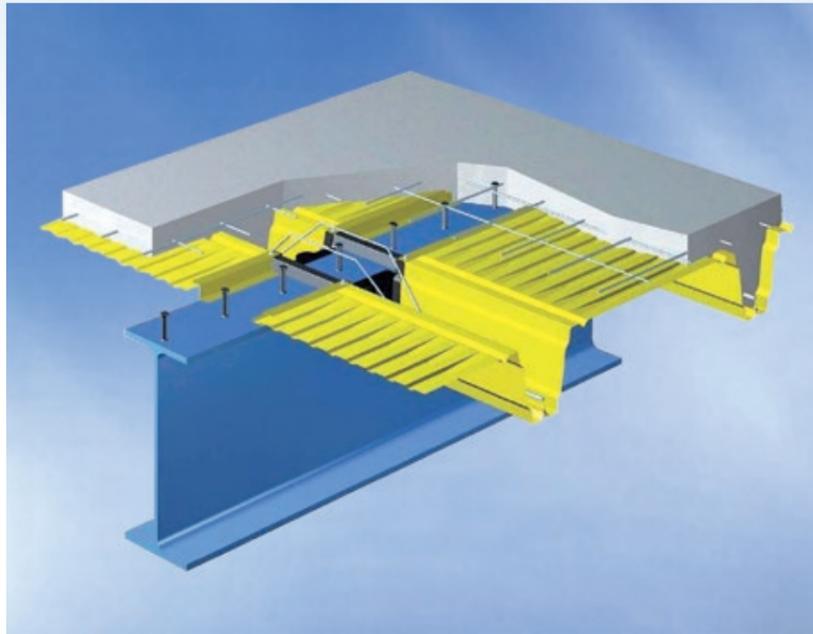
Изображение конструкции перекрытия Hoesch Additif, по стальному каркасу
